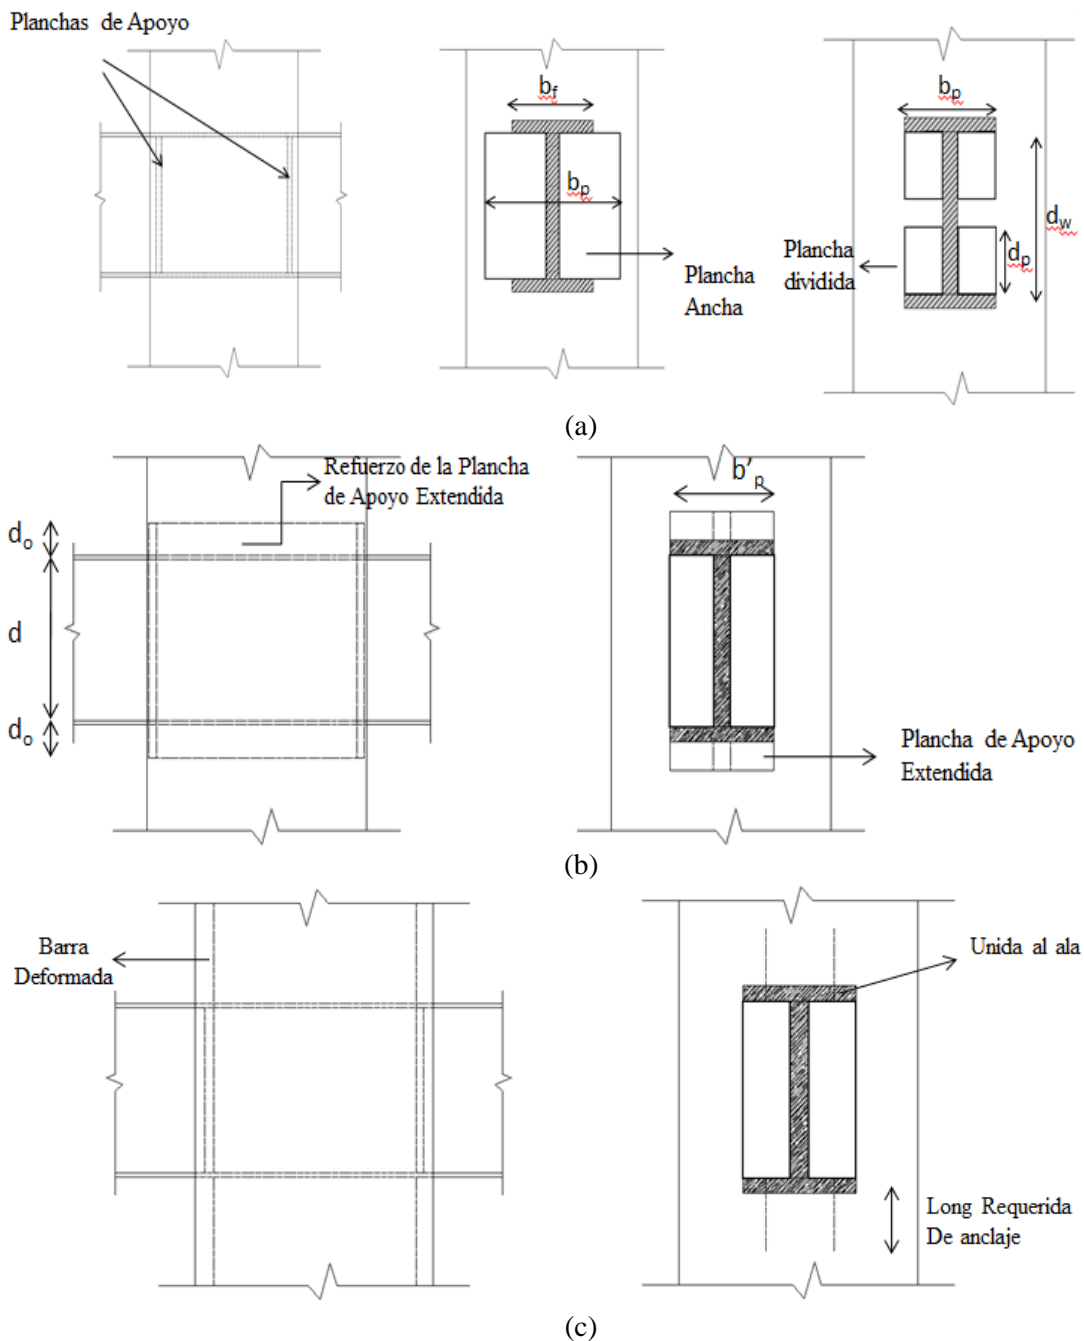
Posible detallado de las juntas. (a) Con placas de apoyo, (b) Con placas de apoyo extendida y (c) Refuerzo vertical en la junta. Nota: Rueda A y Vásquez O (2012).
